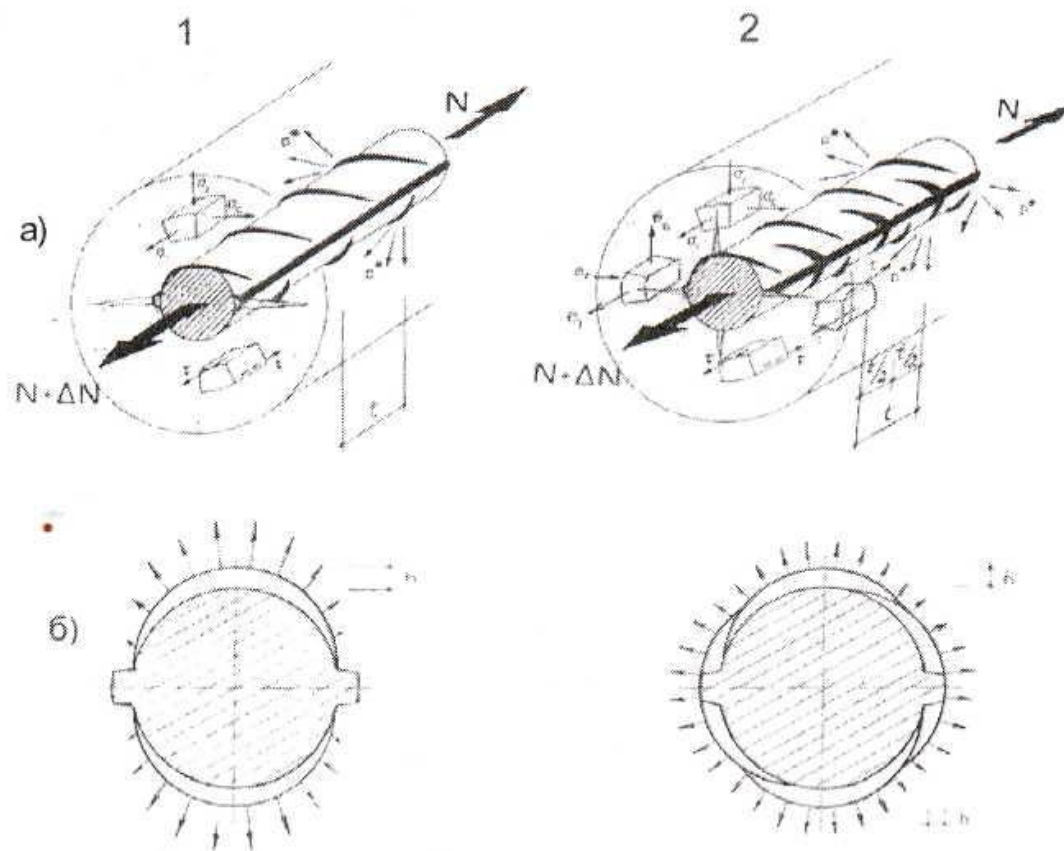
Схема взаимодействия растянутого арматурного стержня с окружающим бетоном
